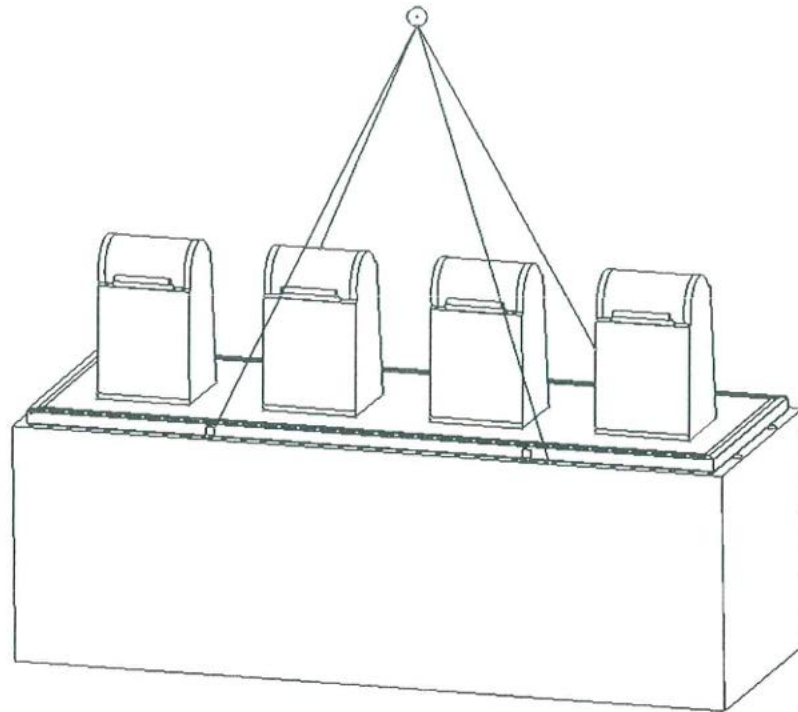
Ridicarea platformei montată pe cuva prefabricată din beton
